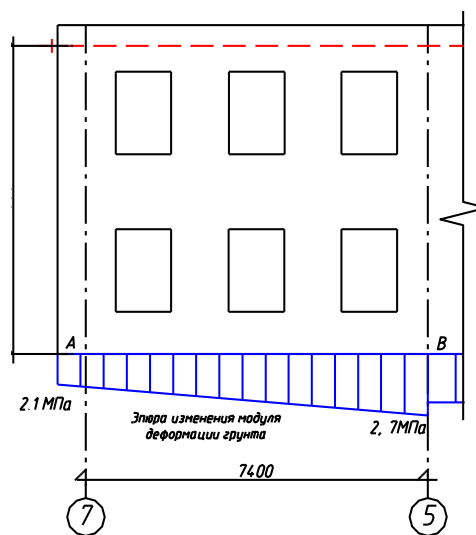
Розрахункова схема об'язувального пояса будівлі
